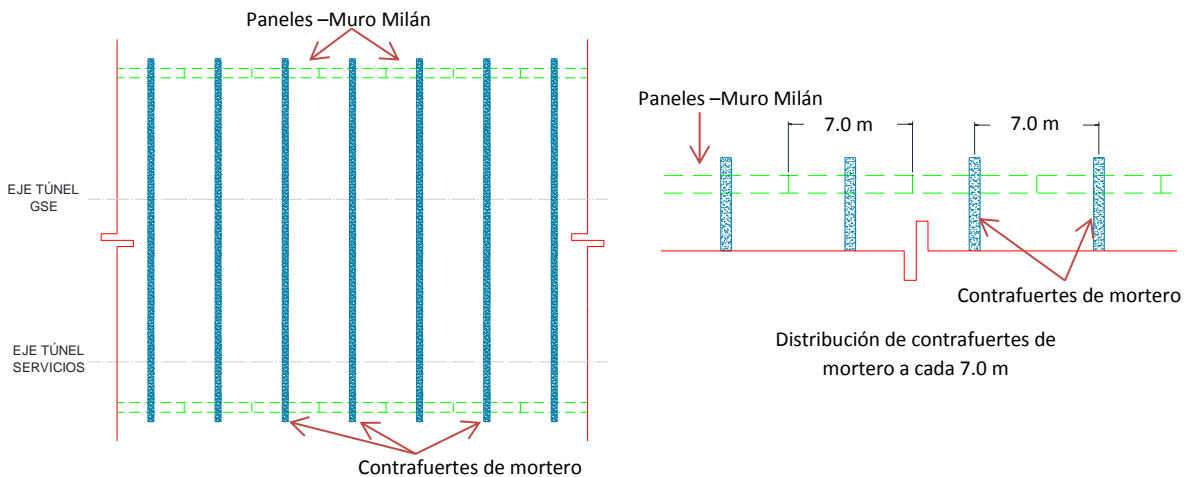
Planta de ubicación de paneles del Muro Milán durante la construcción de los contrafuertes de mortero.
